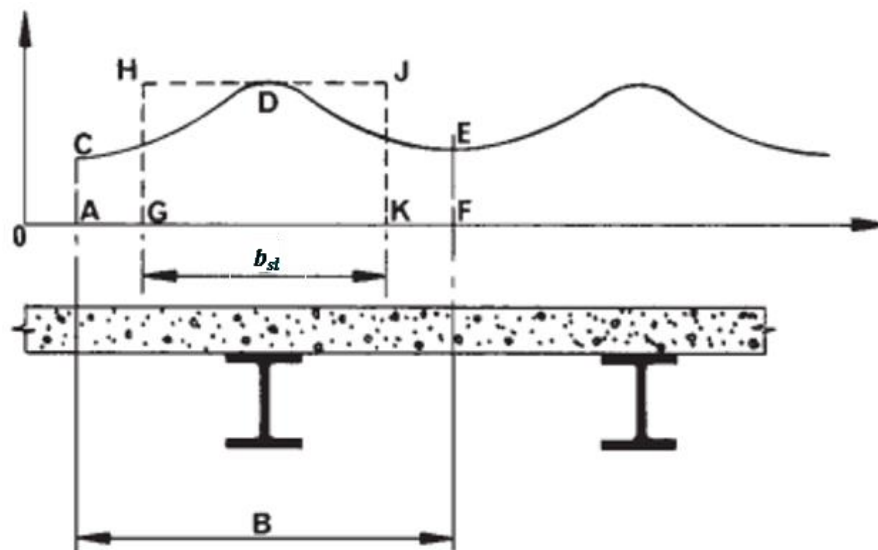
Схема распределения усилий в поперечном сечении сталежелезобетонного перекрытия от изгибающего момента
